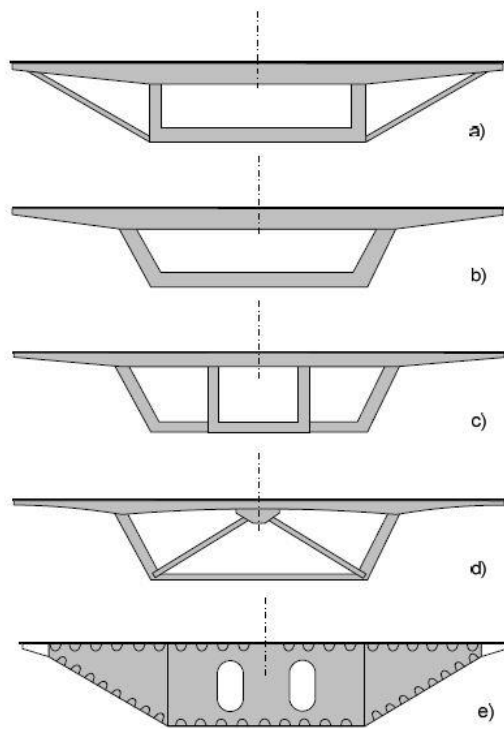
10 - Configurações da secção transversal para uma suspensão central do tabuleiro (Pedro 2010).
